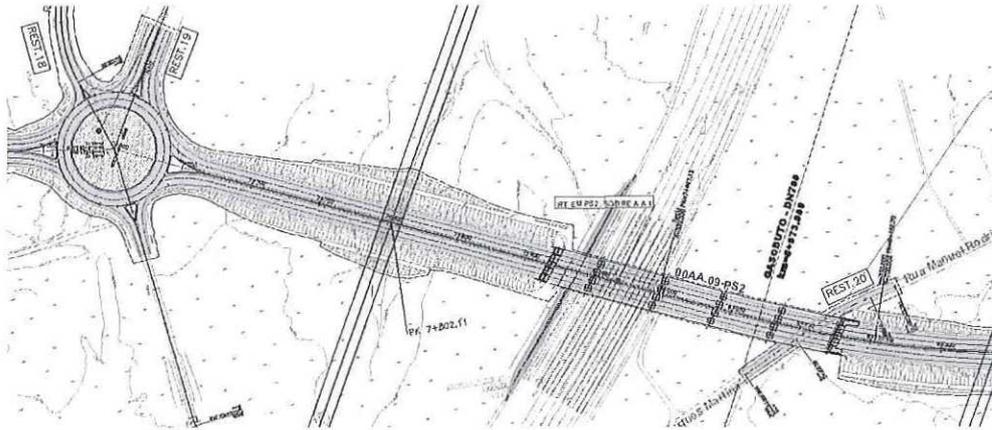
SOLUÇÃO B DO TRAÇADO DA RAVE (ASSINALADO A AMARELO)
